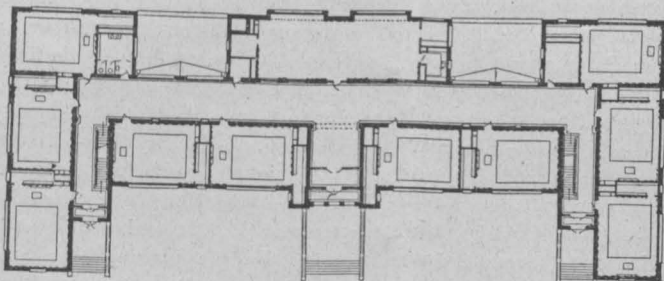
Grundriß zu Abb. 14. (22klassige Schule.)
